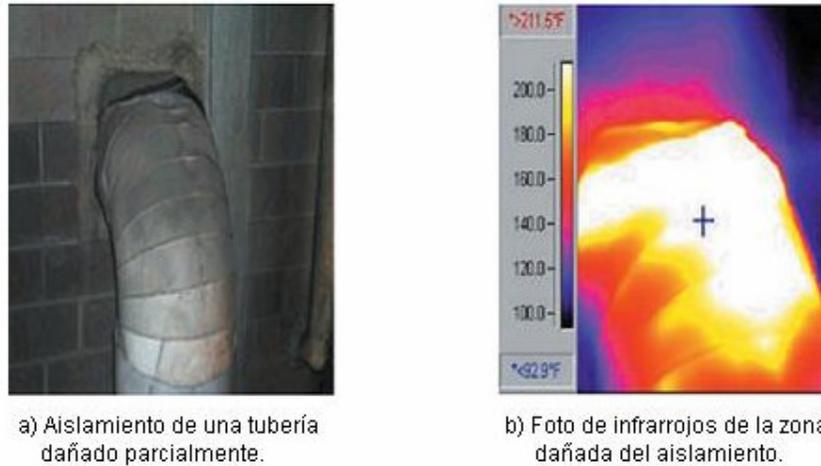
Foto de infrarrojos de un aislamiento dañado.
